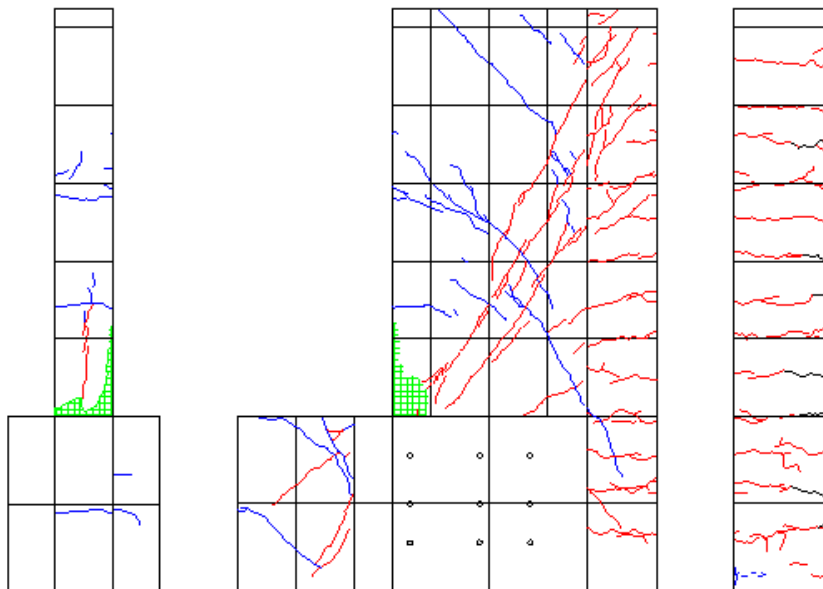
R=-1/50 ひび割れ図
